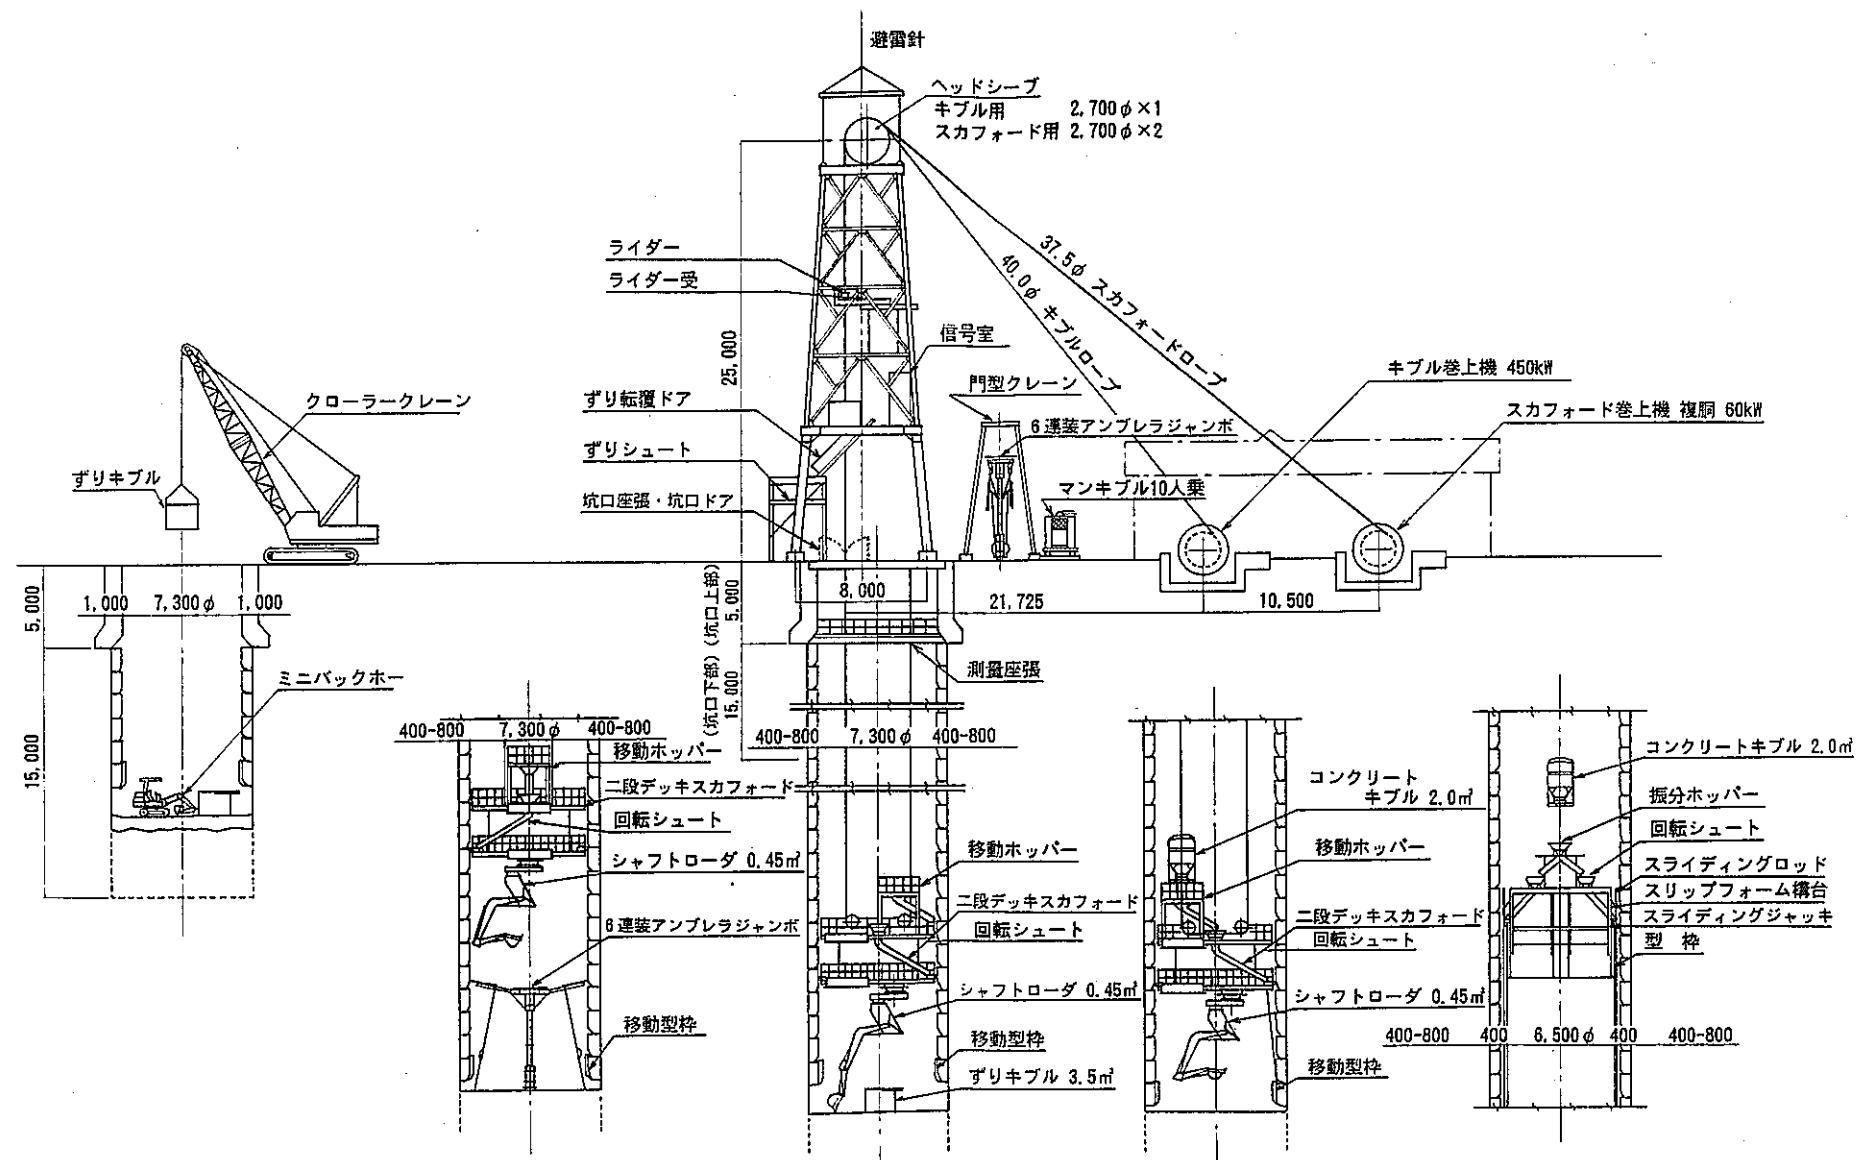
施工・設備概要図（堆積岩・立坑）
